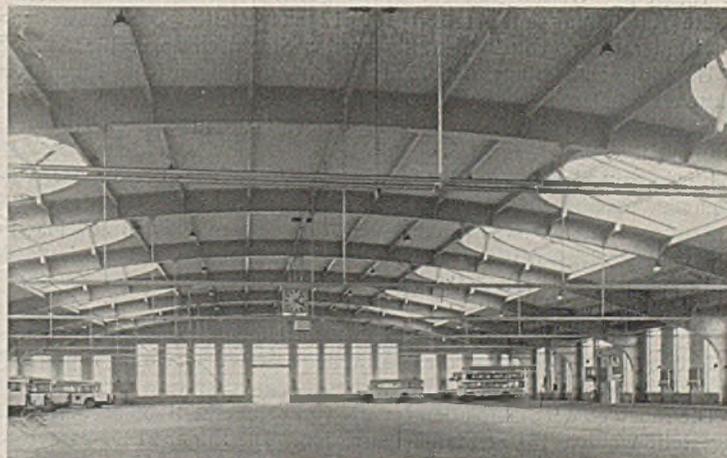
Halle III. Innenansicht mit Blick auf die westliche Giebelwand.
